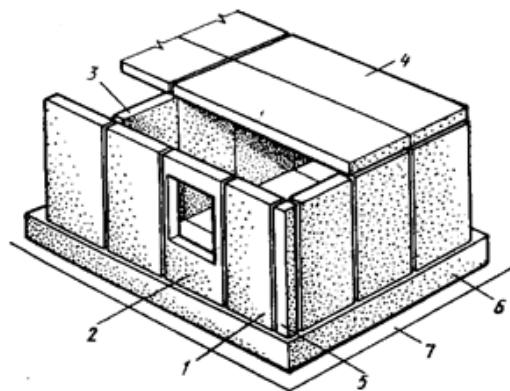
Конструкция дома из панелей: 1 – щит наружной стены; 2 – щит наружной стены с оконным проемом; 3 – щит внутренней стены; 4 – перекрытие; 5 – угловой элемент; 6 – цоколь; 7 – отводка
